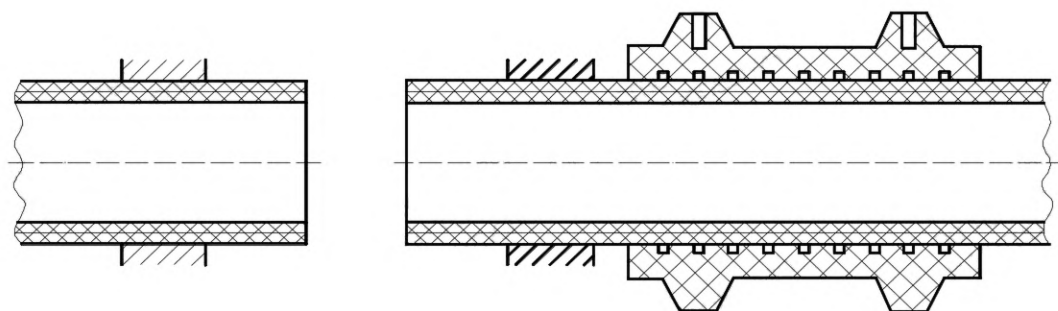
Центровка и закрепление в зажимах сварочной машины концов свариваемых труб
